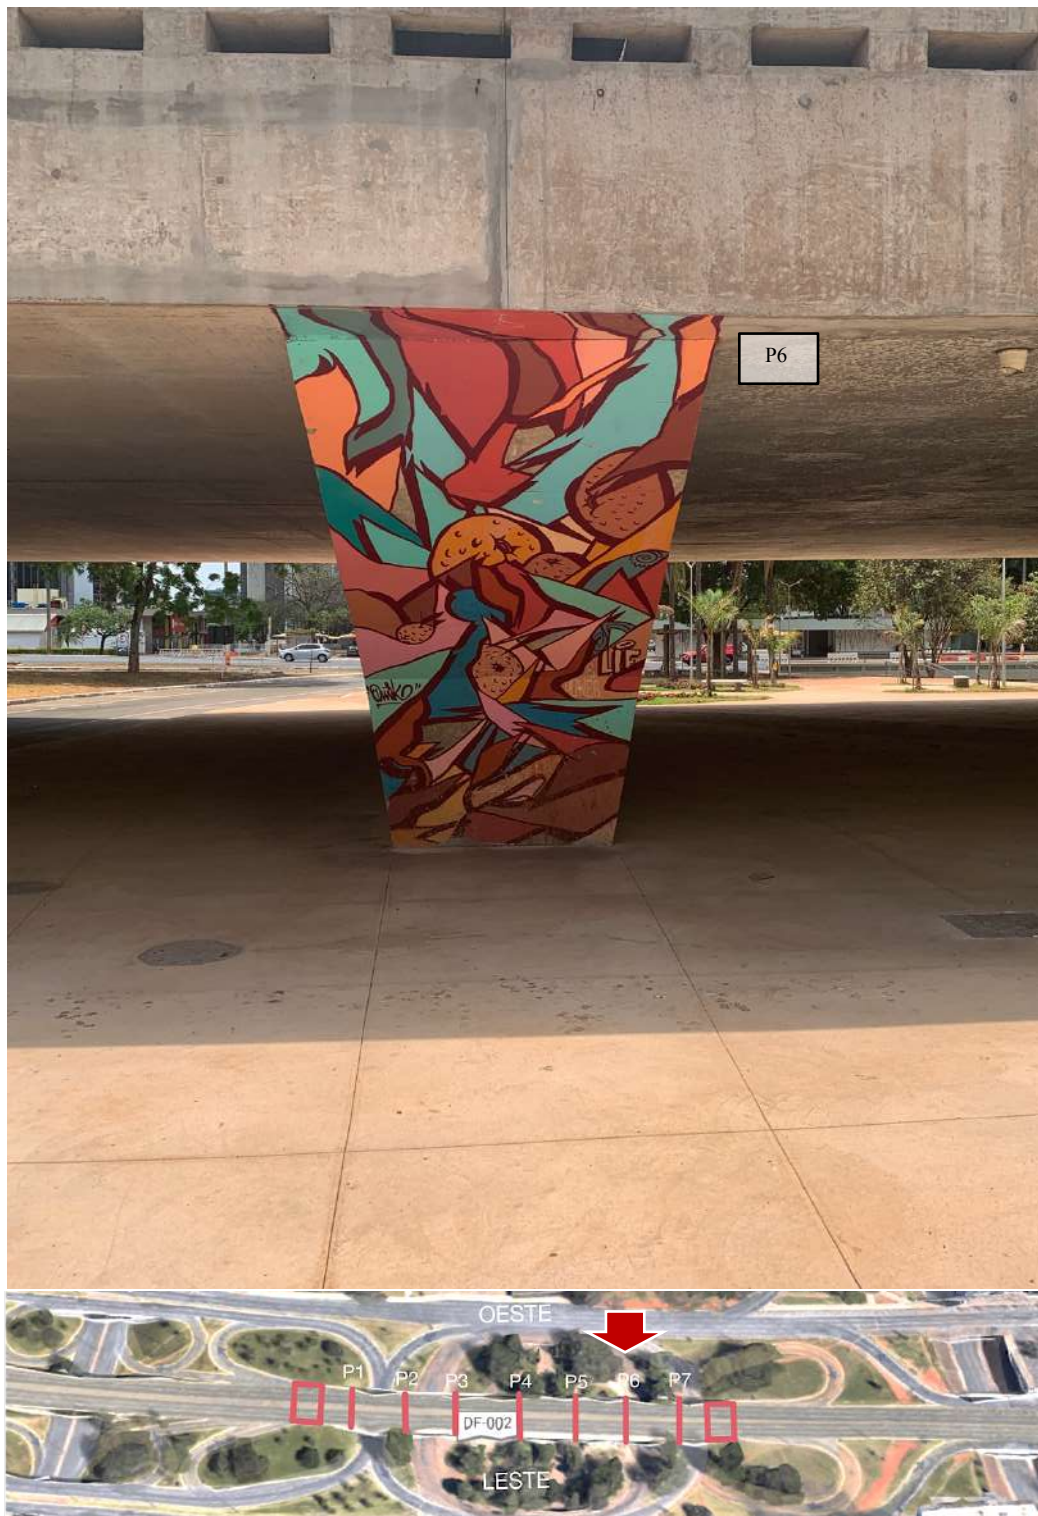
Pilar 6, Lado Oeste, vista frontal. Fonte: autoral / Adaptado de Google Earth
